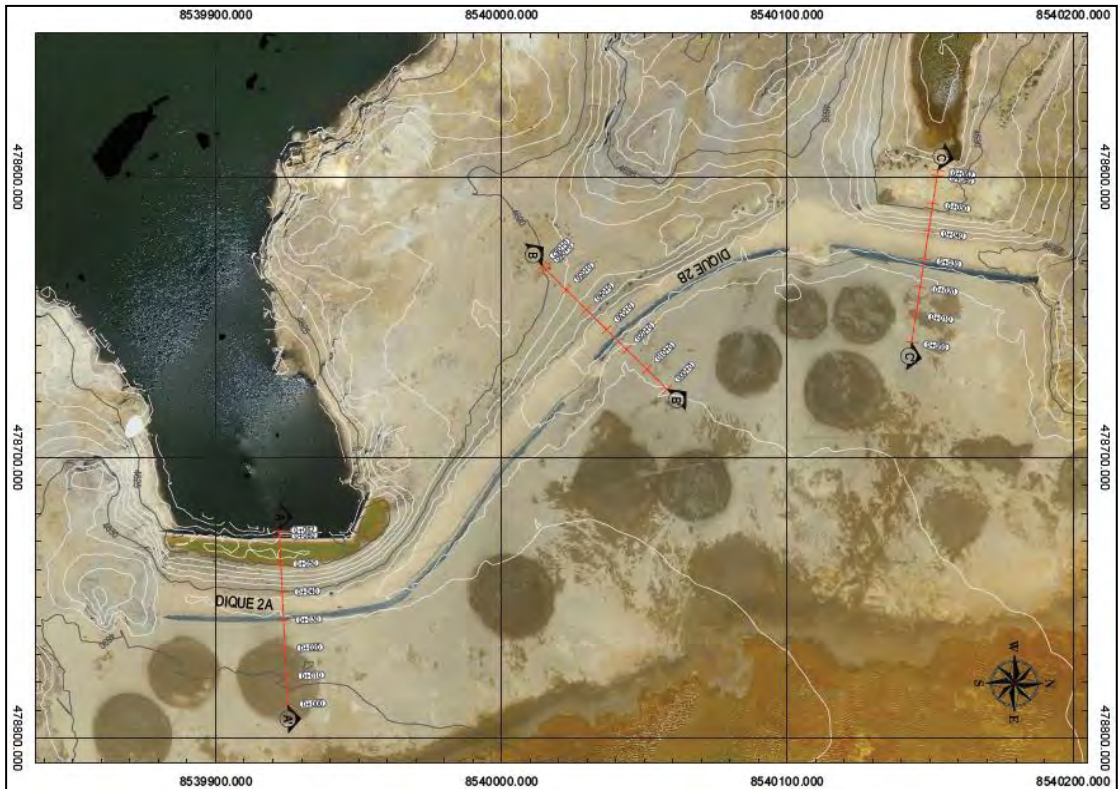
Vista en planta del Dique 2A y 2B, cortes.
